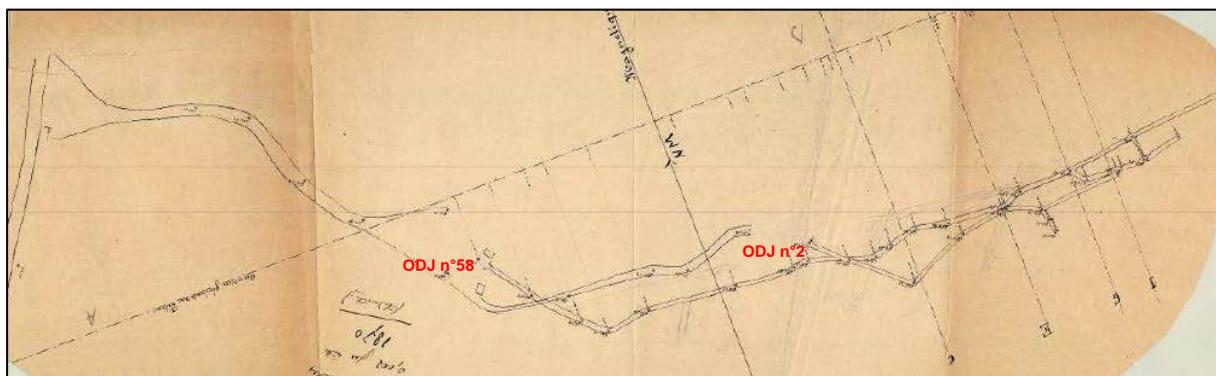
Plan des travaux de la concession des Halles (PV 1870)
